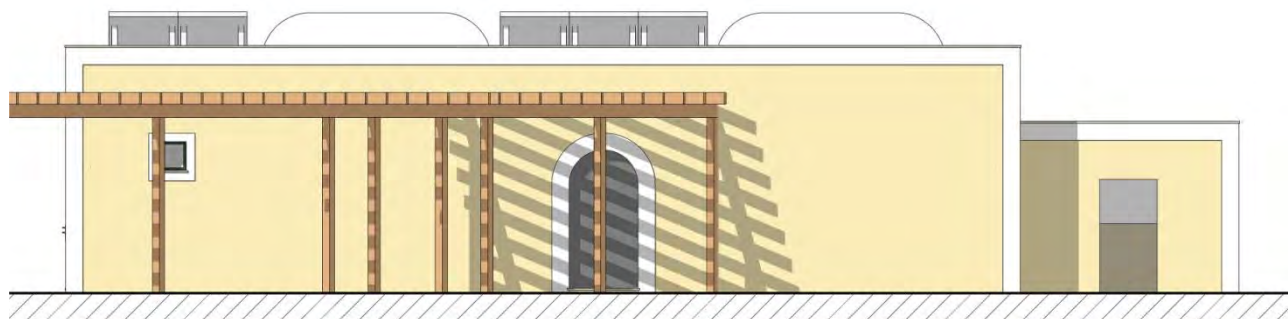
Servizi igienici adiacenti Club House prospetto fronte mare
